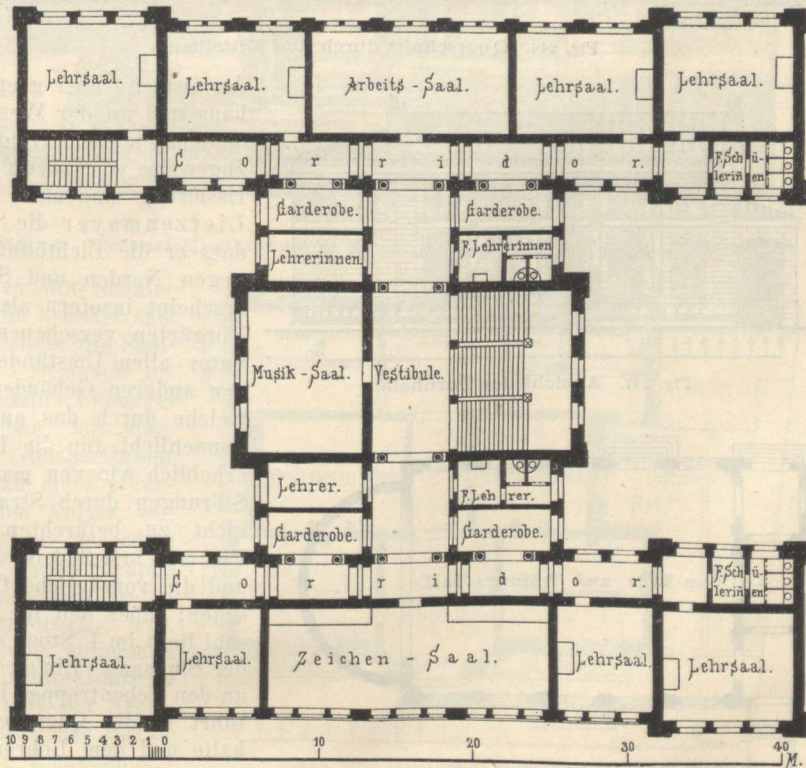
Grundriss vom II. Stockwerk.
